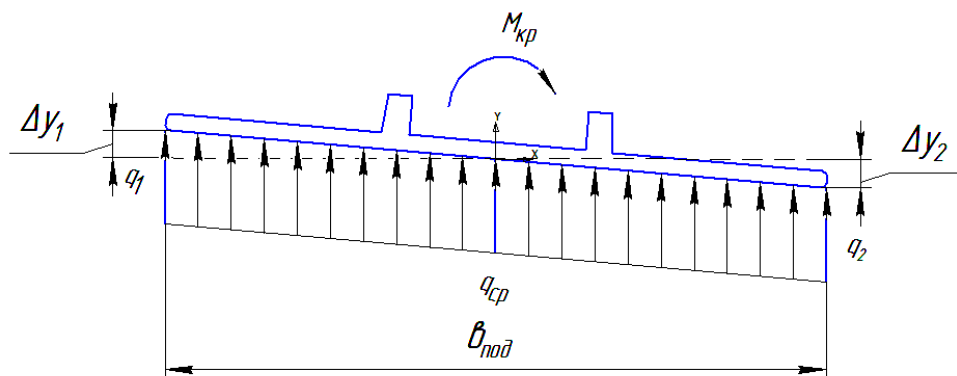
Схема навантаження вузла скріплення ДО крутним моментом
